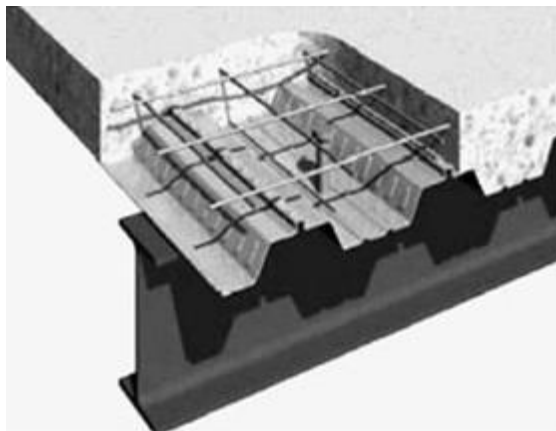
Sistema constructivo losacero UMF #68. Fuente: Google Imágenes.
